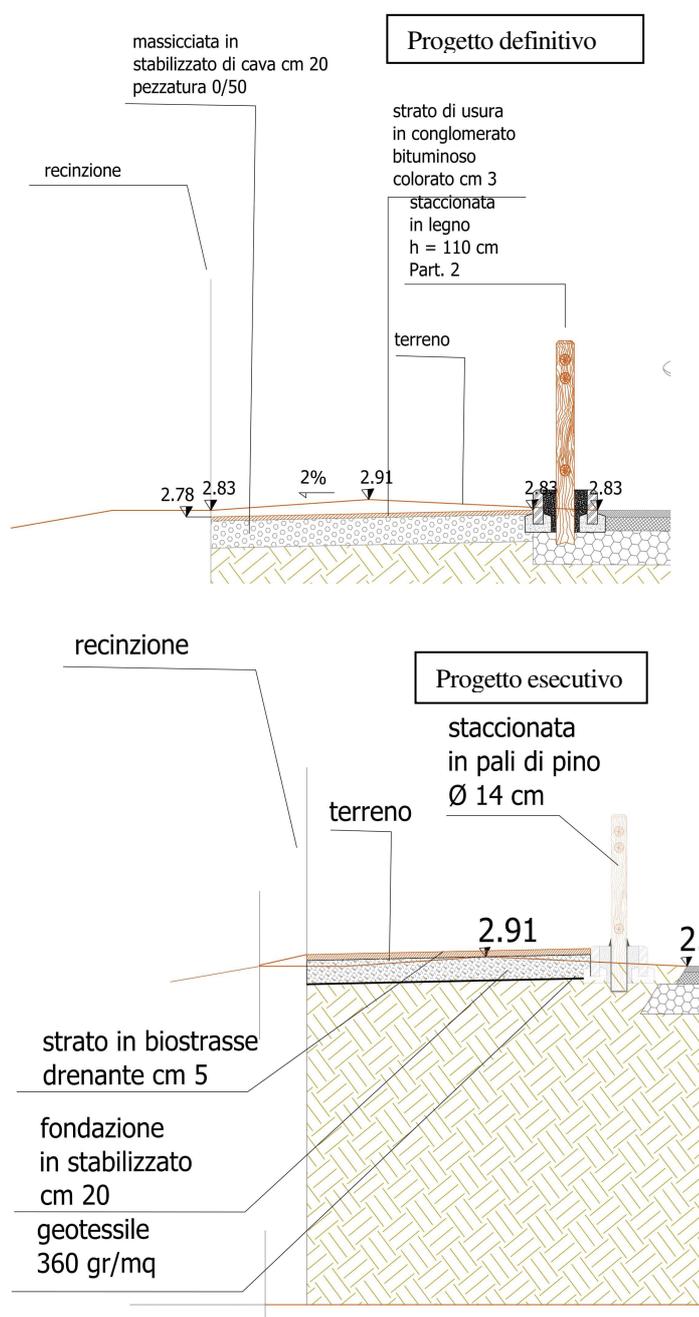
Confronto pavimentazione sezione 8 progetto definitivo-esecutivo (estratto tavola 10 definitivo e tavola 9 esecutivo)
